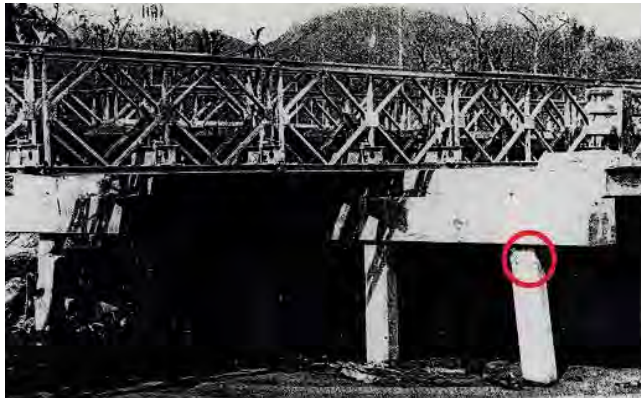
Detalle del estribo colapsado de un puente en Phrom Khiri
